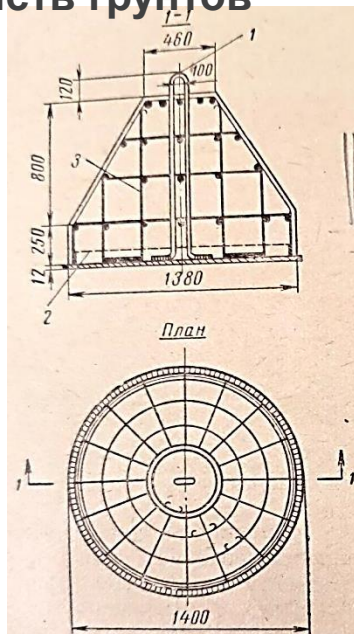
Железобетонная трамбовка диаметром 1,4 м:
